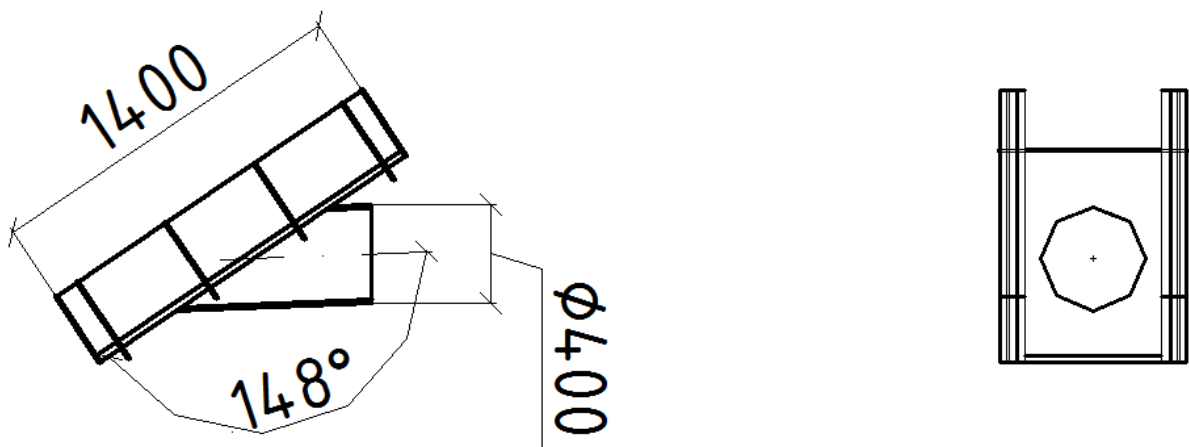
ВД-003.1-1 Быстроток соединительный 400х600 с патрубком.
